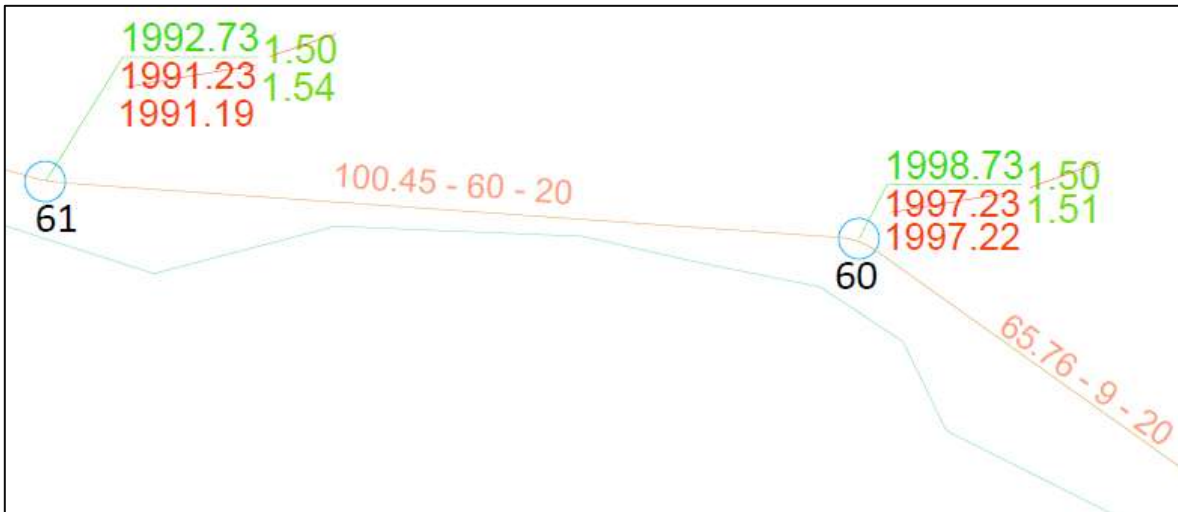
Acercamiento en el plano del proyecto geométrico.
